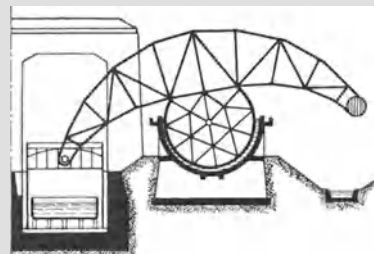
MAN-Hebewerk mit schwimmendem Waggelbalken (senkrechte Hubbewegung). Maßstab 1 : 1100.
